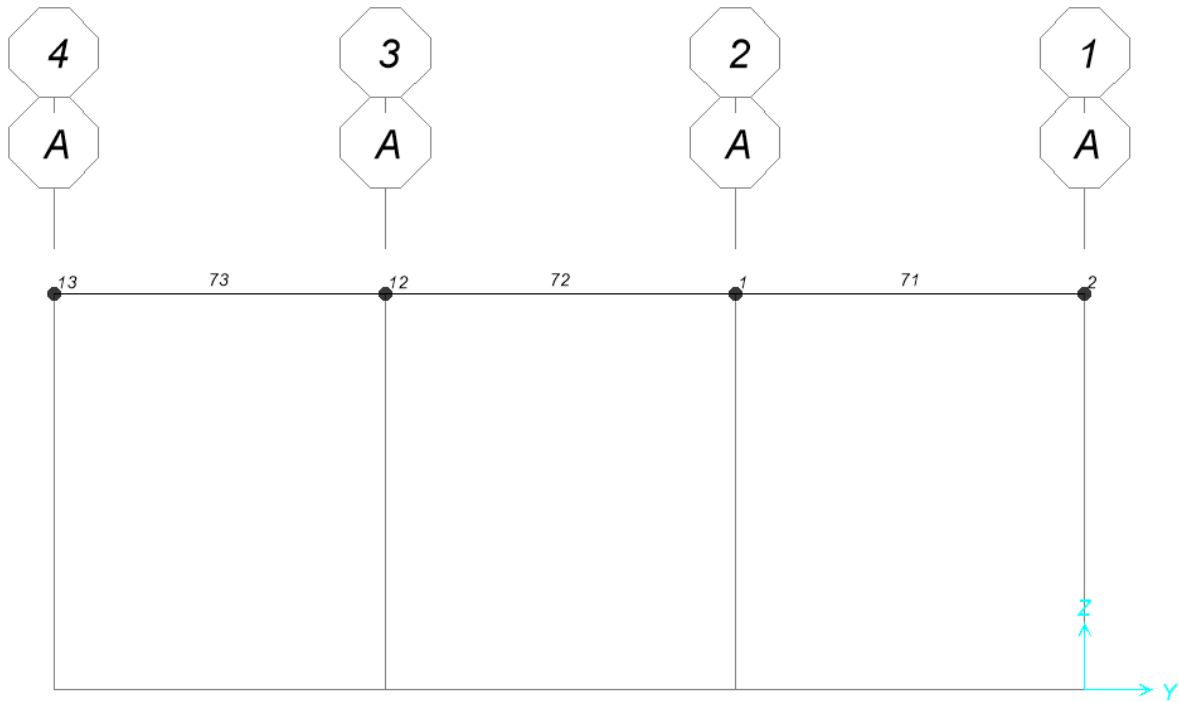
Vista in sezione modello struttura in elevazione –Filo A - numerazione elementi frame e joint
